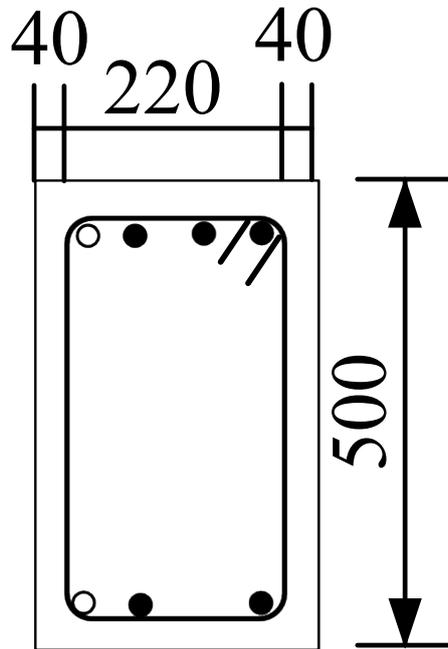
SH/SLB 梁試體斷面圖(輔助筋 D13)(單位：mm)
